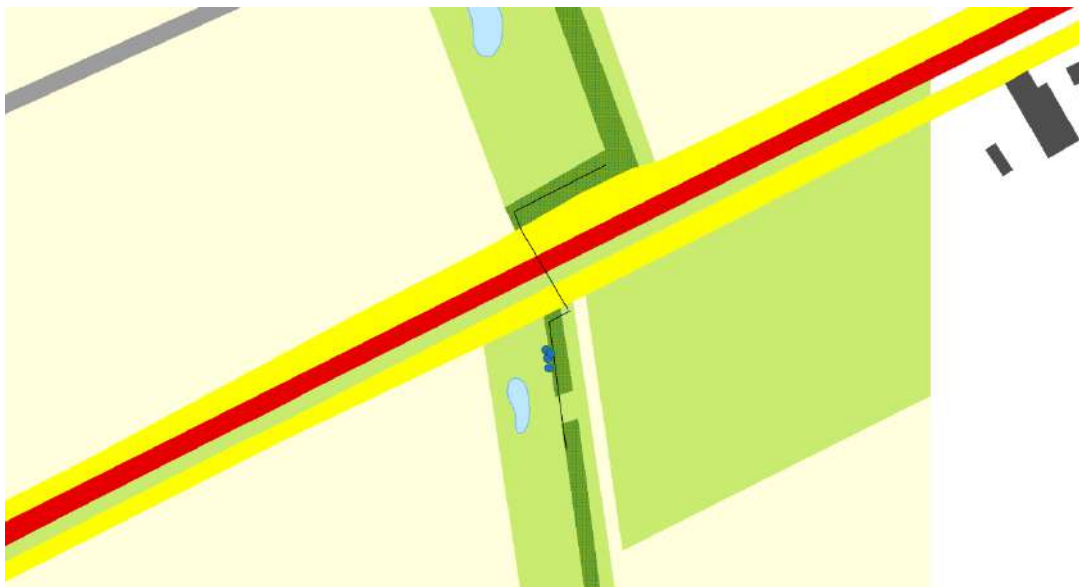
Globale ligging van bestaande faunapassages binnen het plangebied (rood).
